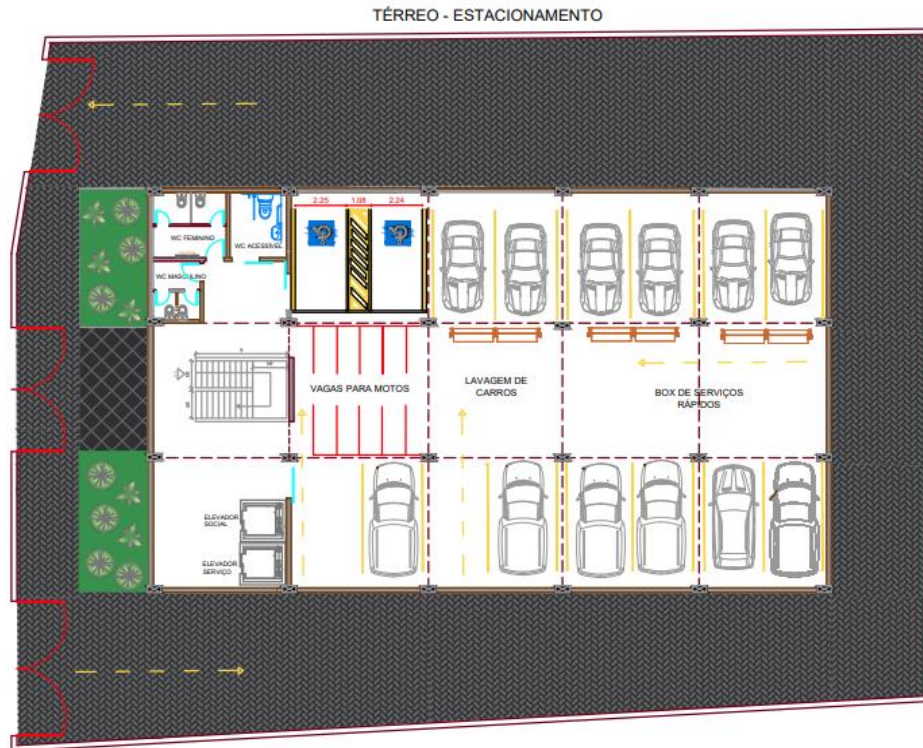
Planta Baixa Pavimento Térreo. Fonte: dos Autores 2024.
